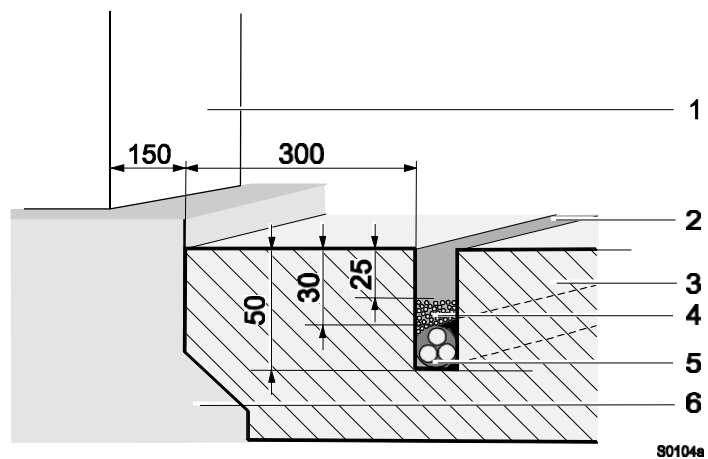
Colocar o laço indutivo em betume, asfalto ou cimento (Dimensões em mm)
